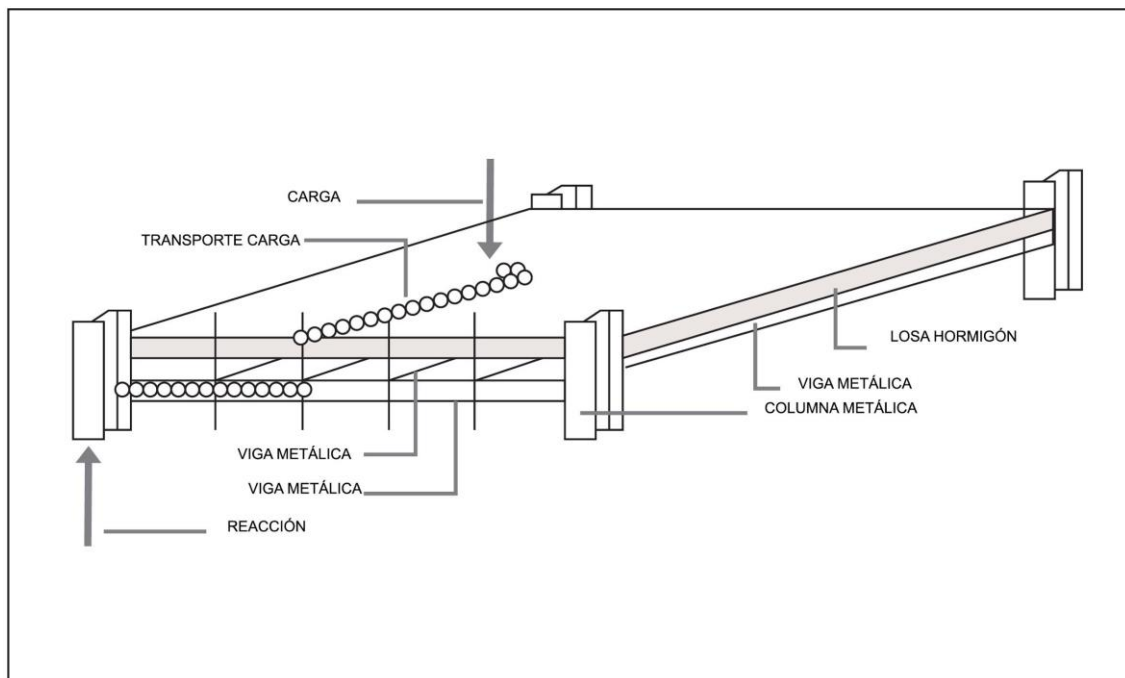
Losa Tradicional vaciada en obra sobre estructura metálica
